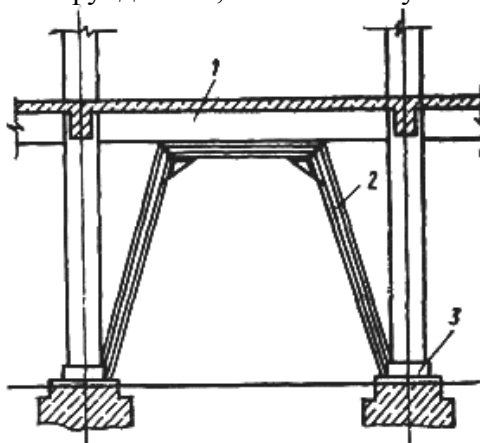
Усиления ригеля жестким порталом: 1 – усиливаемый ригель; 2 – жесткий портал; 3 – металлический бандаж
